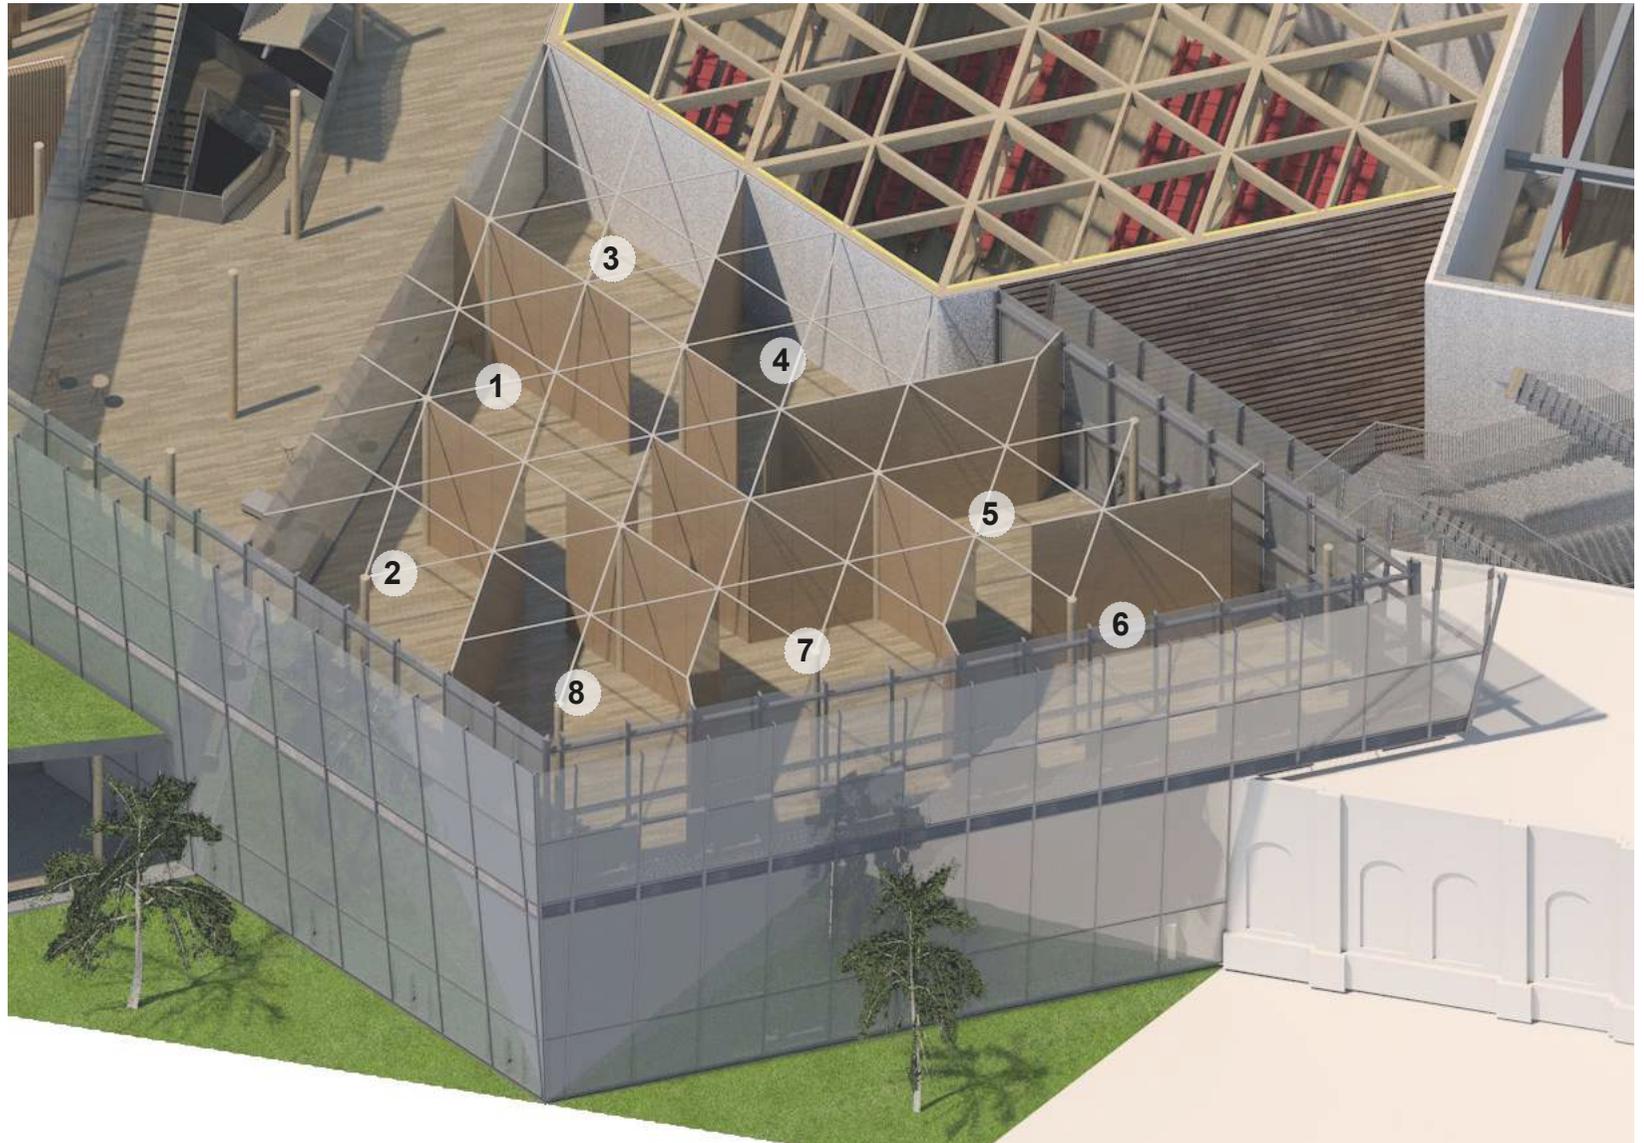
Eigene Darstellung: Trennwände Variante 6
